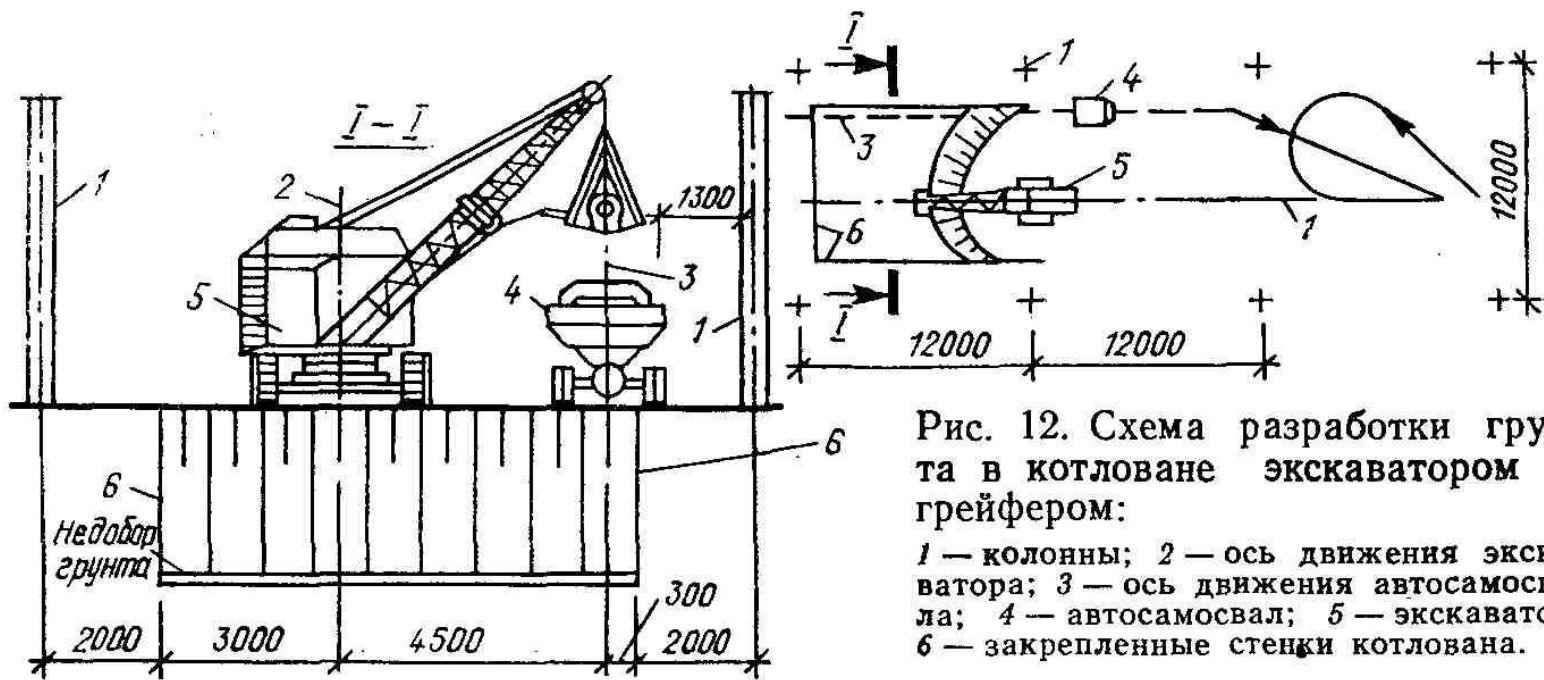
Схема разработки грунта в котловане экскаватором с грейфером:
